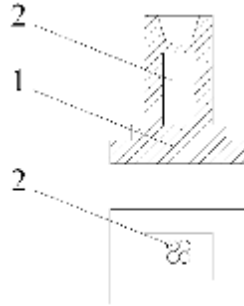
Отдельный фундамент из пустотообразователей: 1 - массив фундамента, 2 - пустотообразователи
